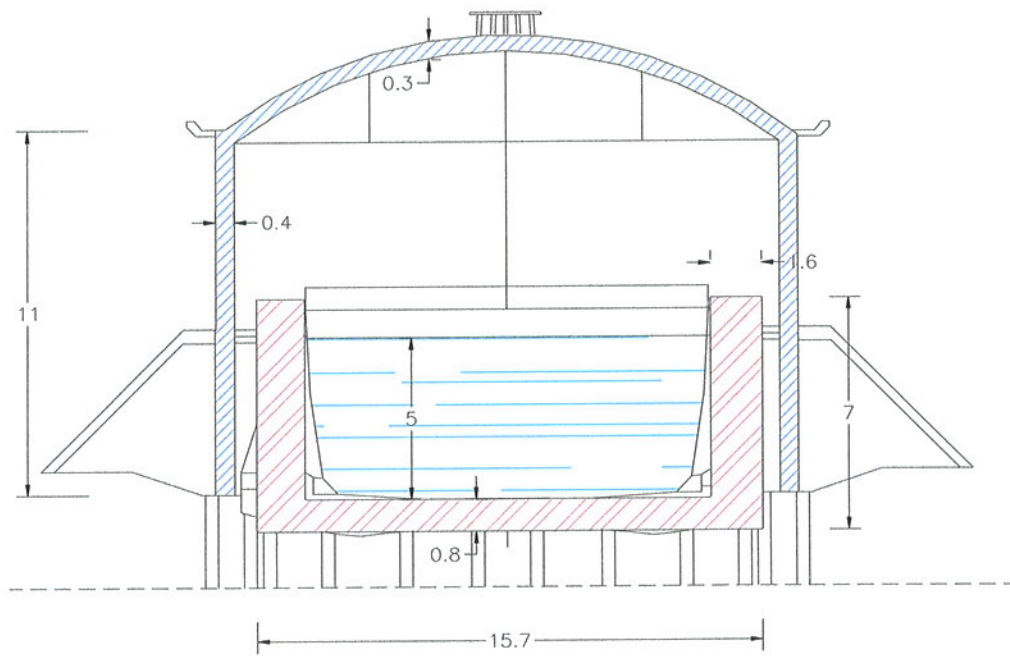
Sezione trasversale – Geometria di calcolo
